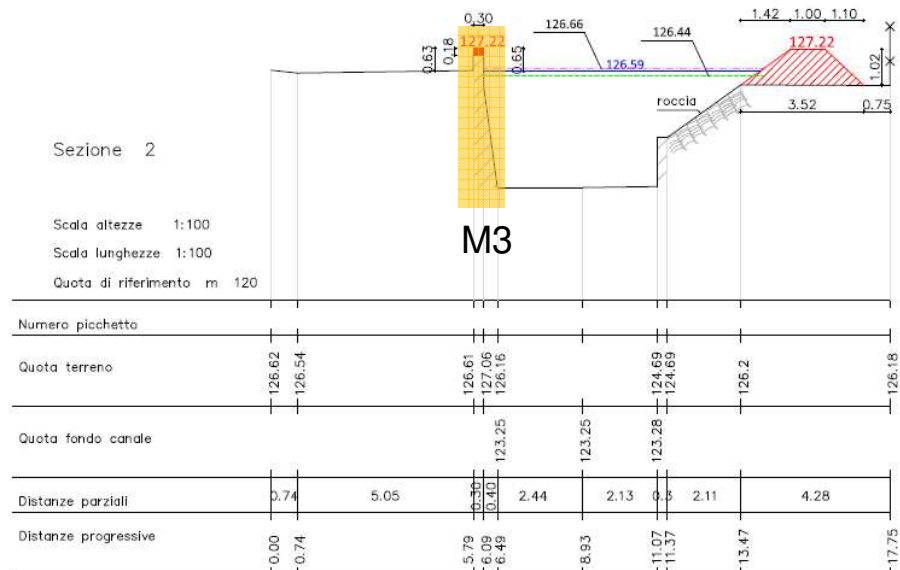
Sezione 2 di sovrapposizione (SITO 2):muro spondale M3 (giallo).
